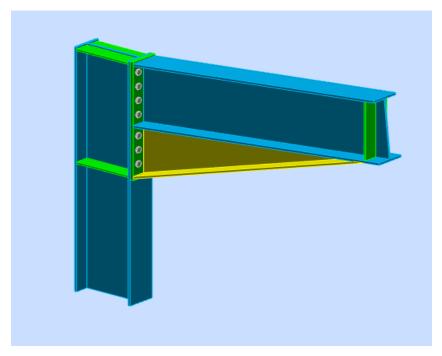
Vue 3D de l'assemblage poteau poutre de rive
